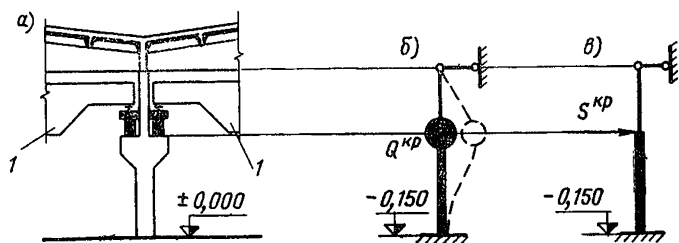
Схемы к расчету колонны на местную сейсмическую нагрузку от собственного веса моста крана
